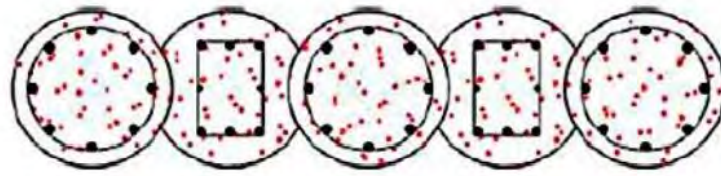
Armado de pilote primarios en pantalla de pilotes secantes duro/duro. (Fuente: Cementation Skanska, 2009)
